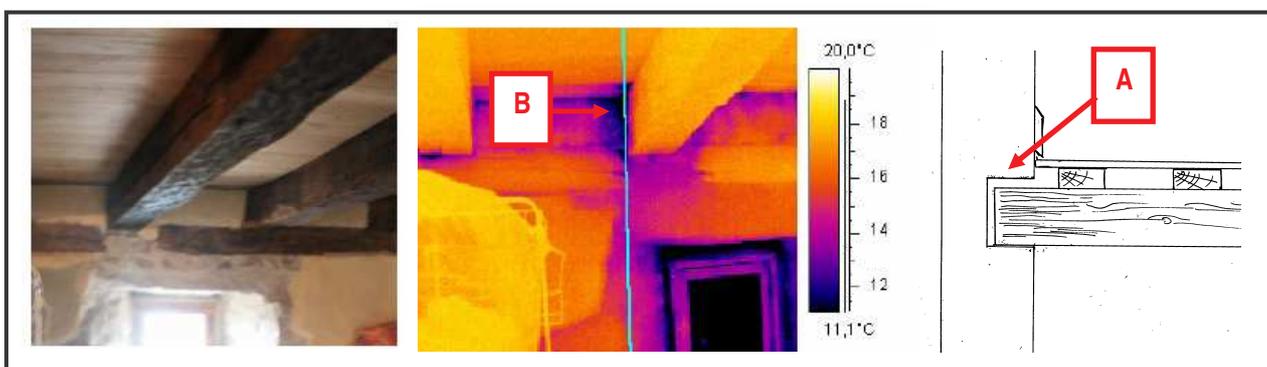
cas d'un plancher simple à poutres encastrées apparentes (bâtiment 7)
